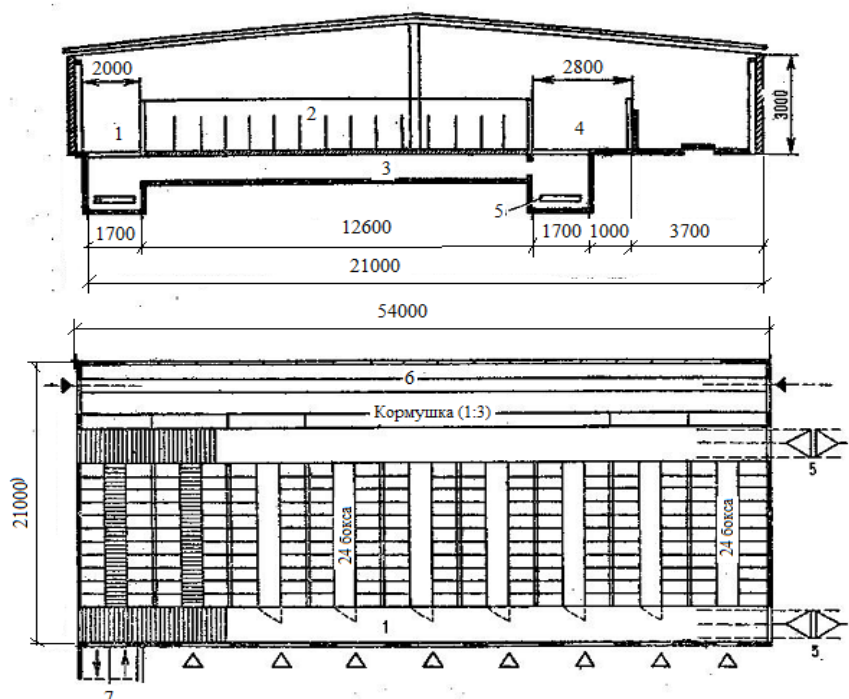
Разрез и схема коровника с поперечным расположением боксов:
